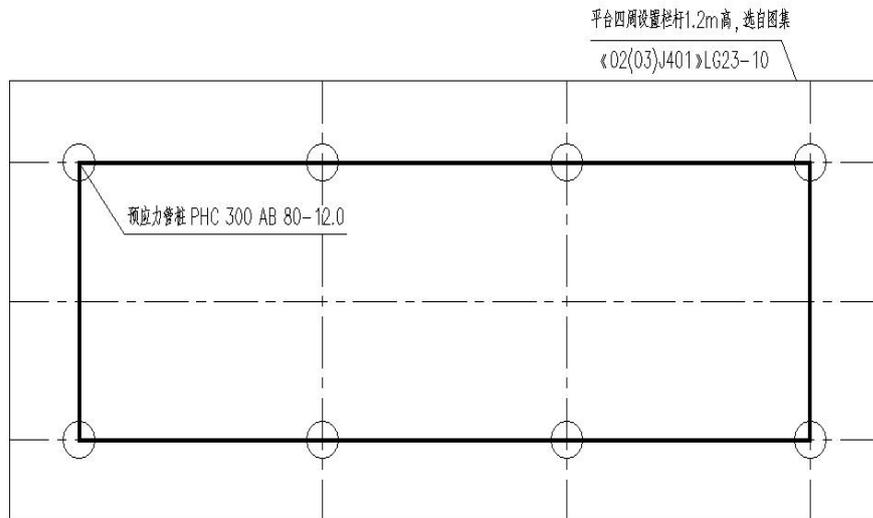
逆变器、箱变设备基础桩基平面布置示意图
